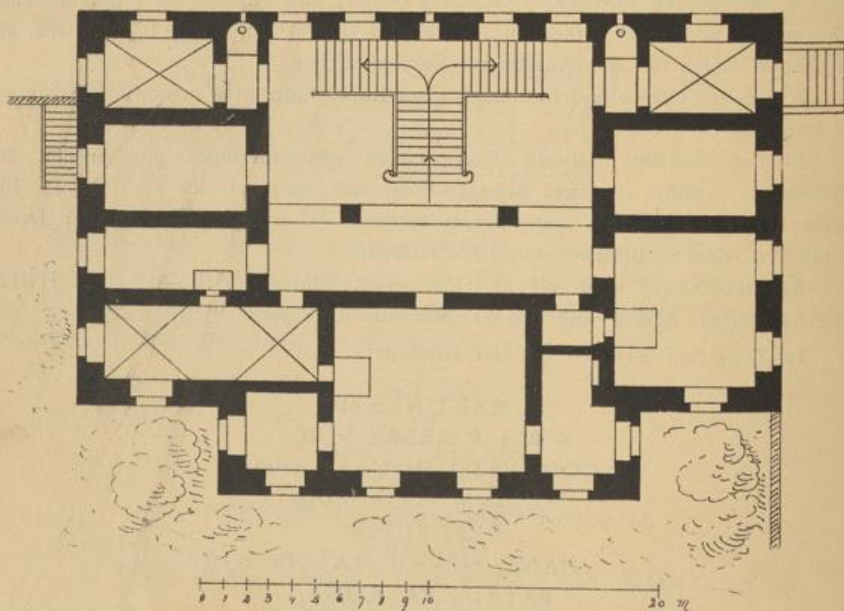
Todtmoos. Ehemaliger Palast, jetzt Pfarrhaus. Grundriss.
